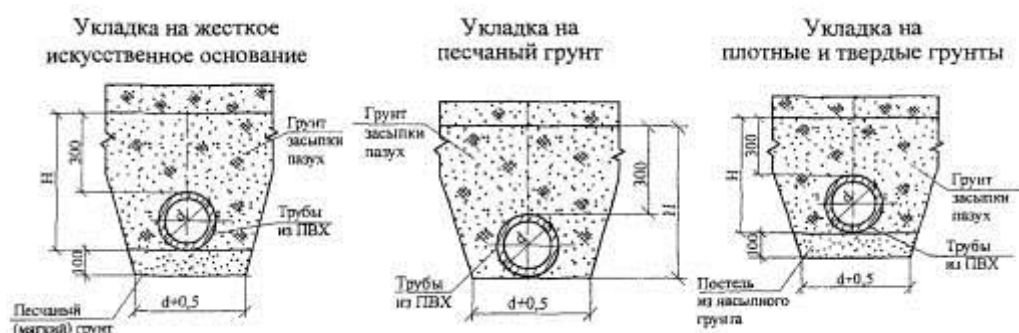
Схемы укладки труб из ПВХ в грунте
